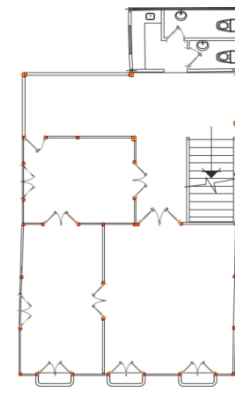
Plano de planta baja de la Casa Cevallos Arizaga. (INPC, 2017)
